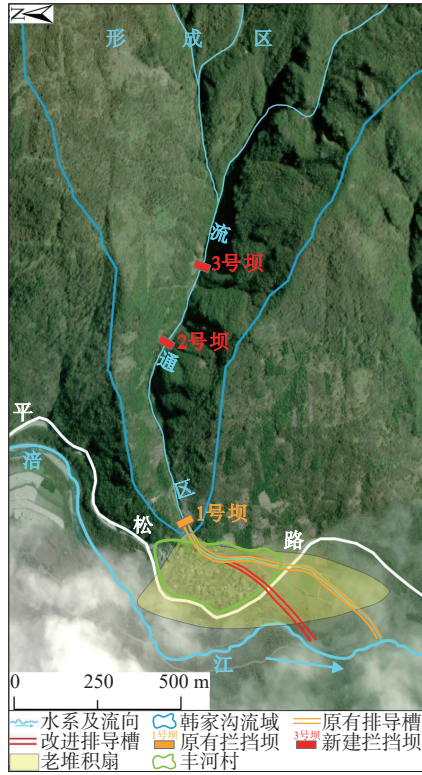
韩家沟泥石流防治工程改进前后工程布置平面图
